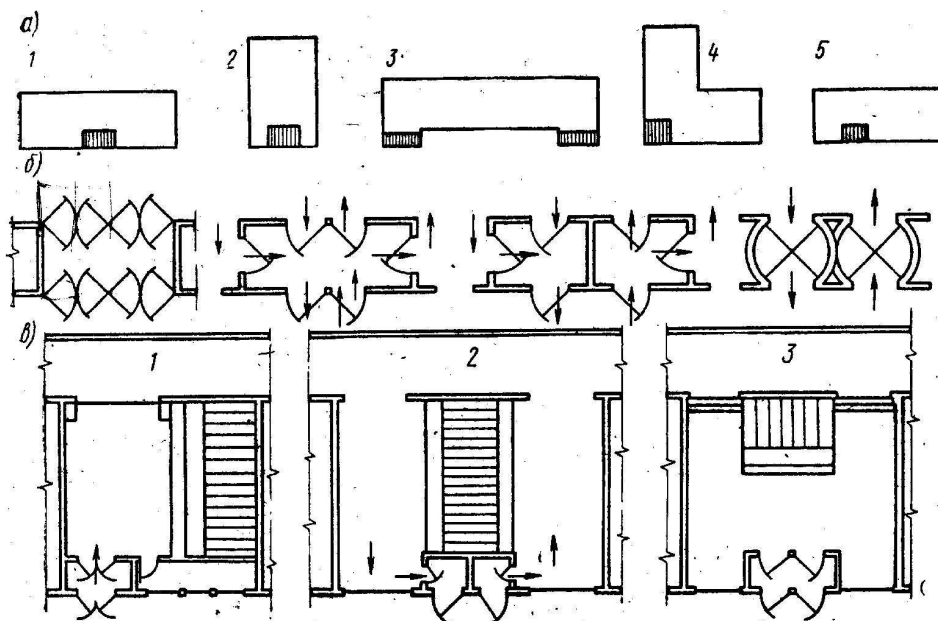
Планувальні схеми входних вузлів громадських будівель: а – місце знаходження входного вузла в плані будівлі; б – типи тамбурів і входів; в – схема планування вестибюлю: 1 – одностороннє розташування гардеробу; 2 – центральне двостороннє; 3 – центральне одностороннє.
